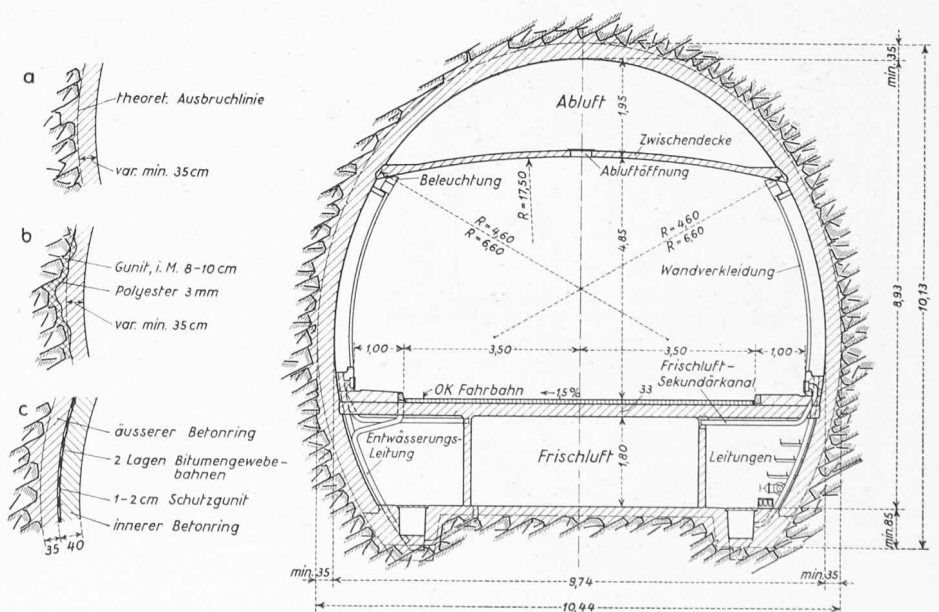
Tunnel-Normalprofil, Masstab 1:150. Gewölbe-Einzelheiten: a) normale Ausführung, b) Ausführung in stark wasserführenden Tunnelabschnitten, c) Ausführung in den Portalstrecken
